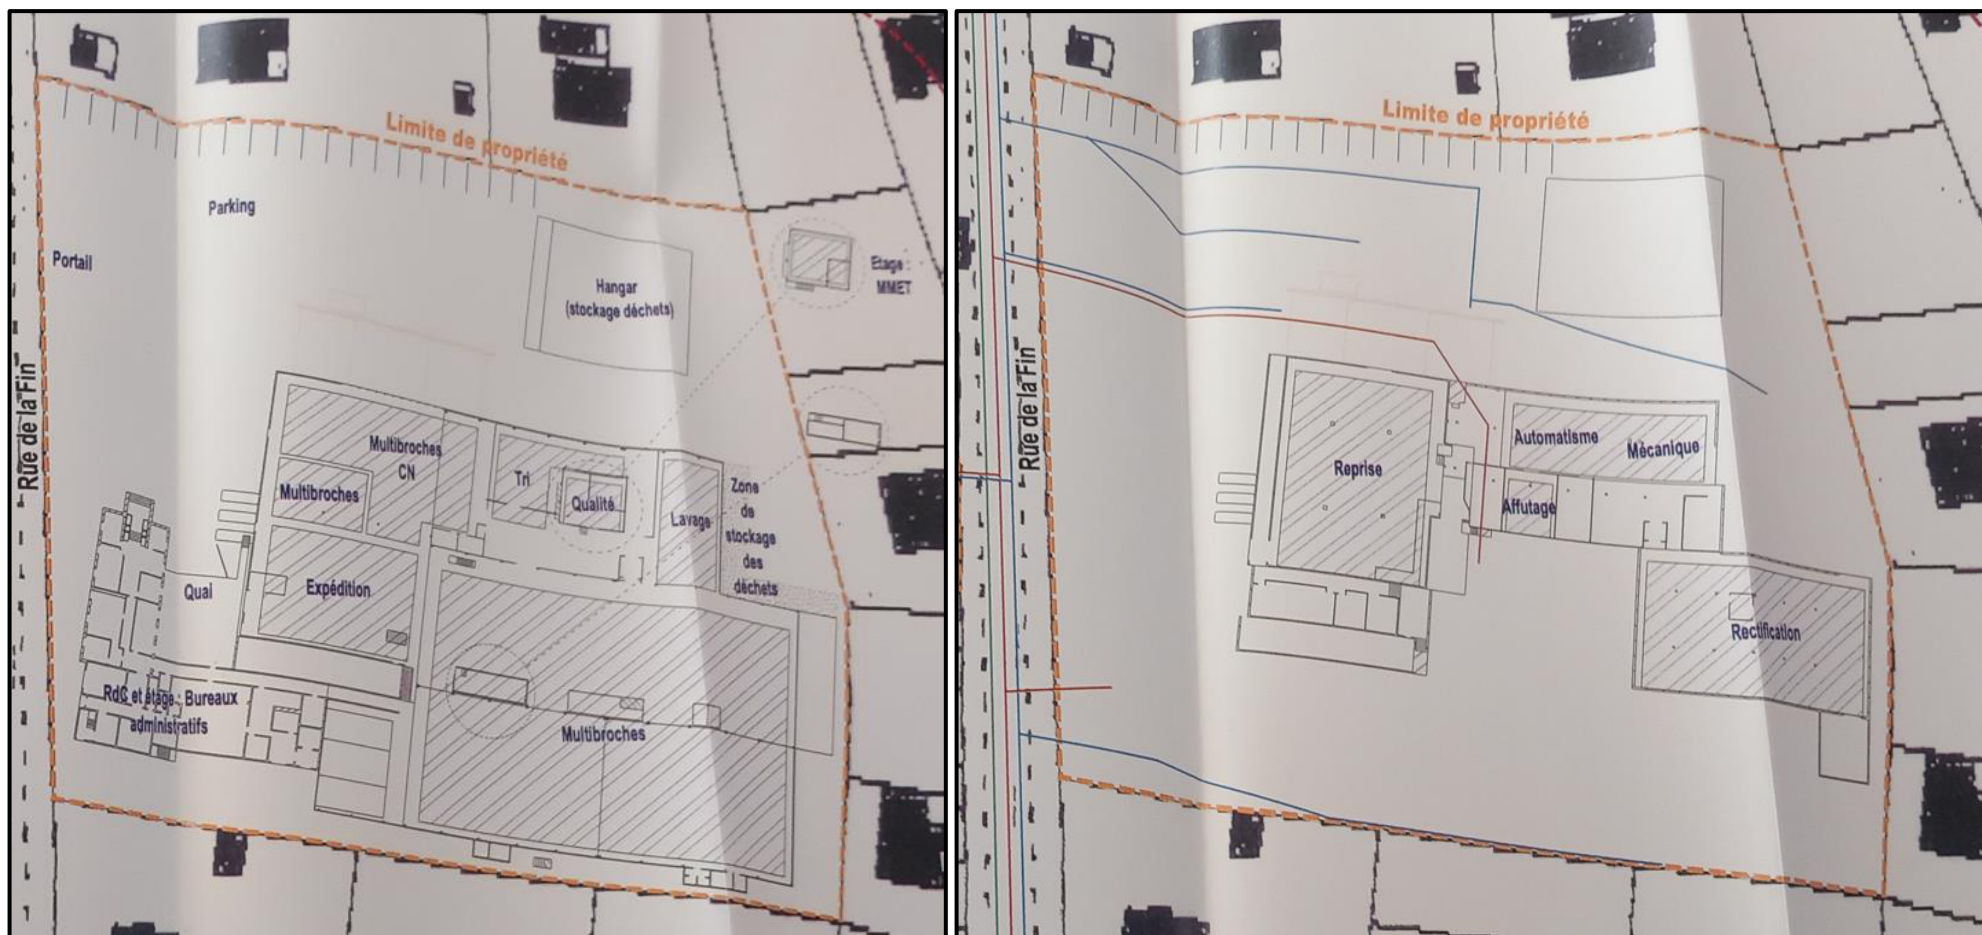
Plan du site EBEA en 2003 – RDC et 1^{er} étage (à gauche) et sous-sol (à droite)
